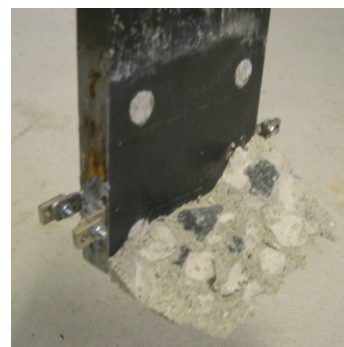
意図しない形態で破壊が生じた試験体 (B タイプ)
